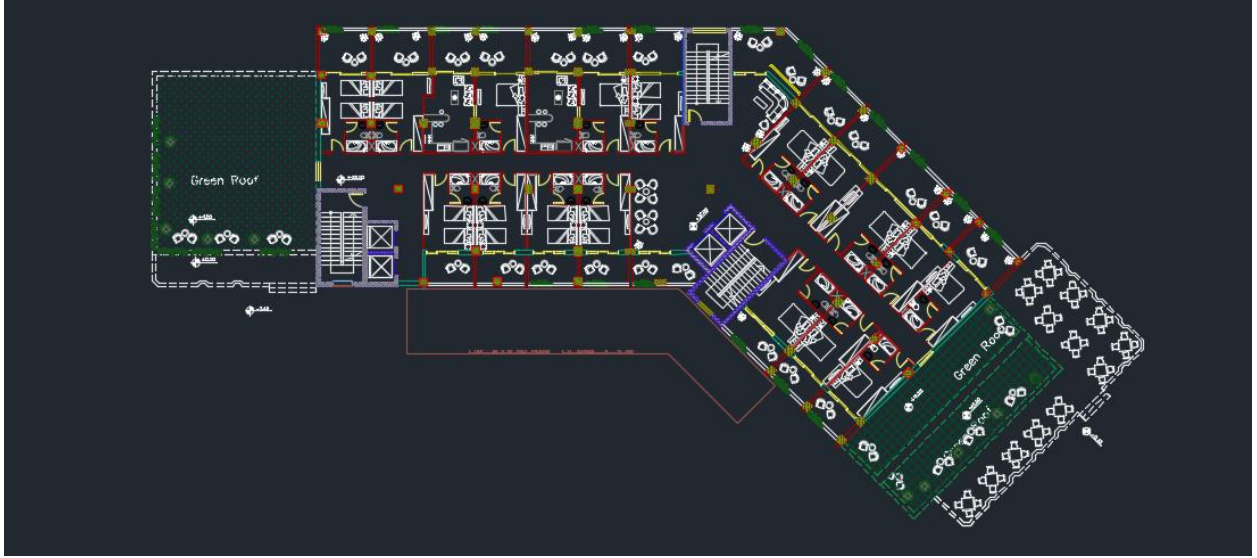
المسقط الأفقي للطابق الخامس.
